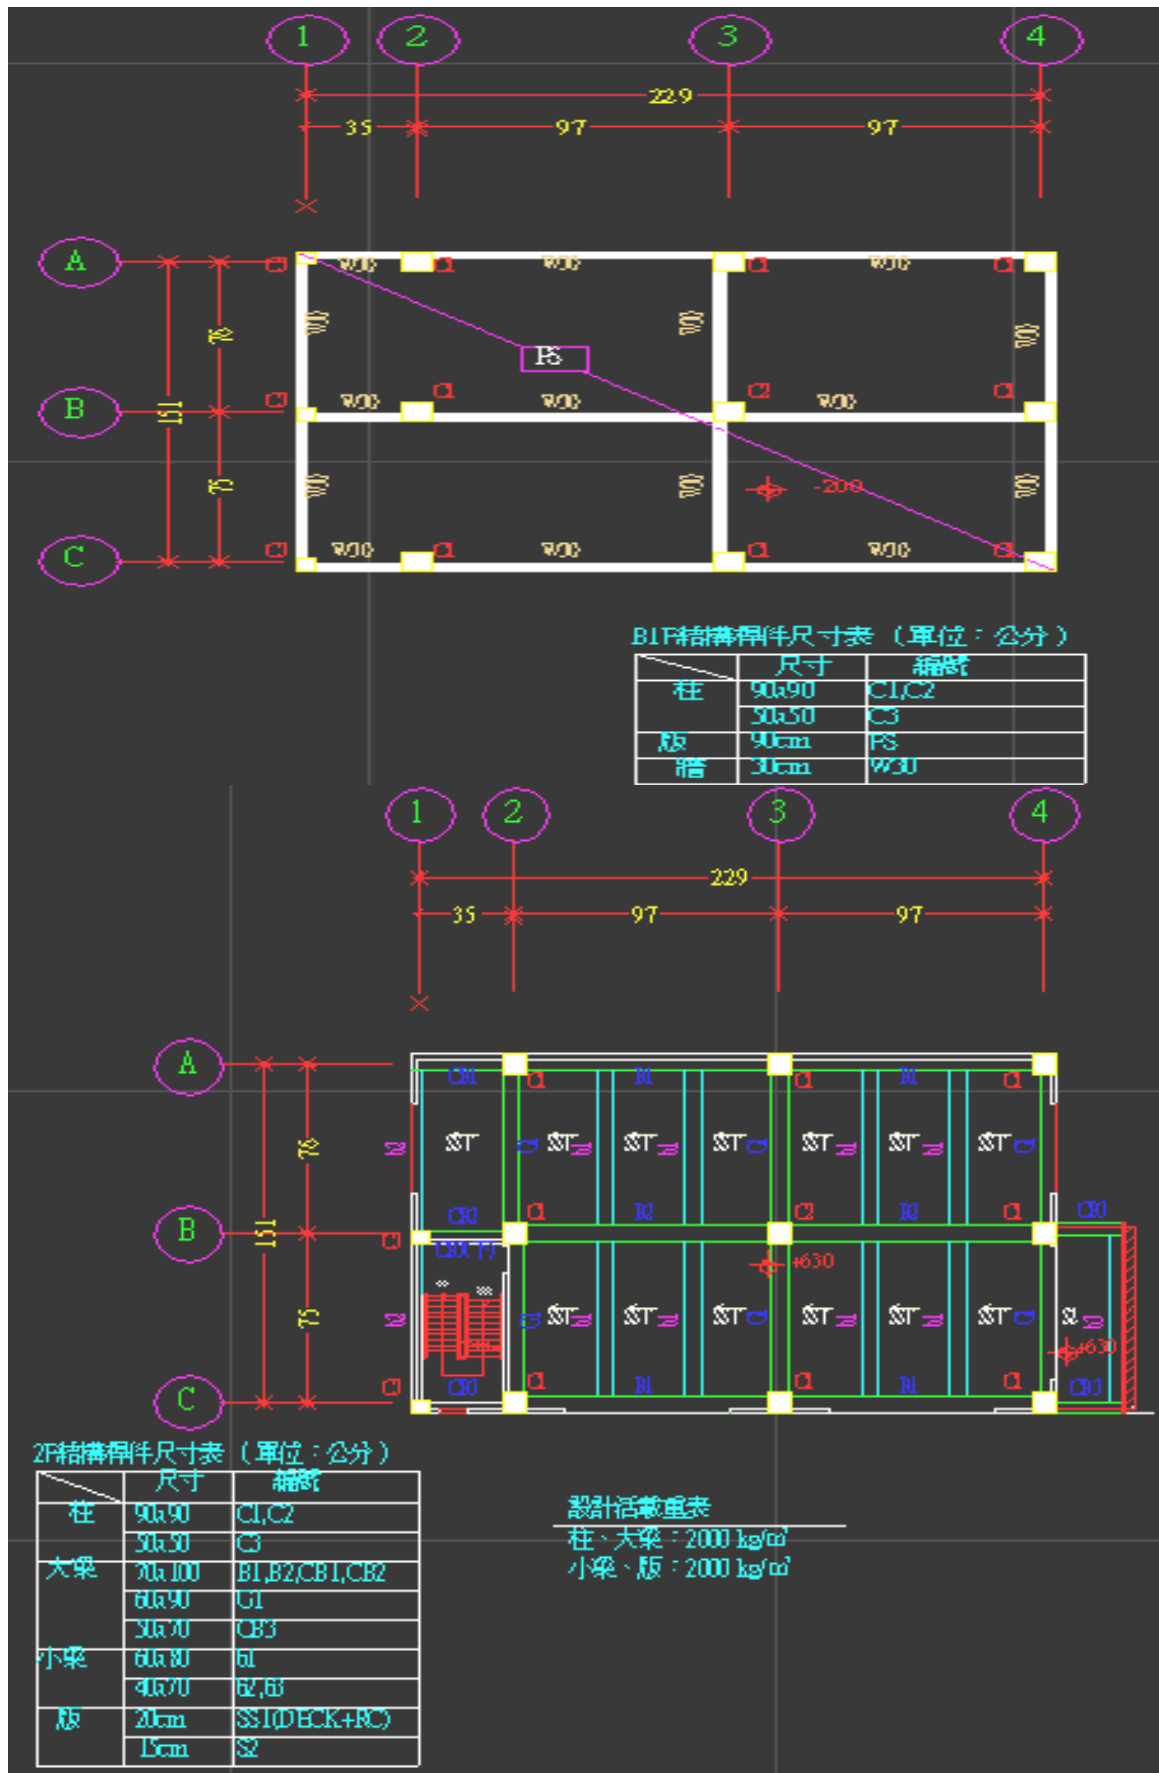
AutoCAD 繪製 傳統 2D 平面圖示
